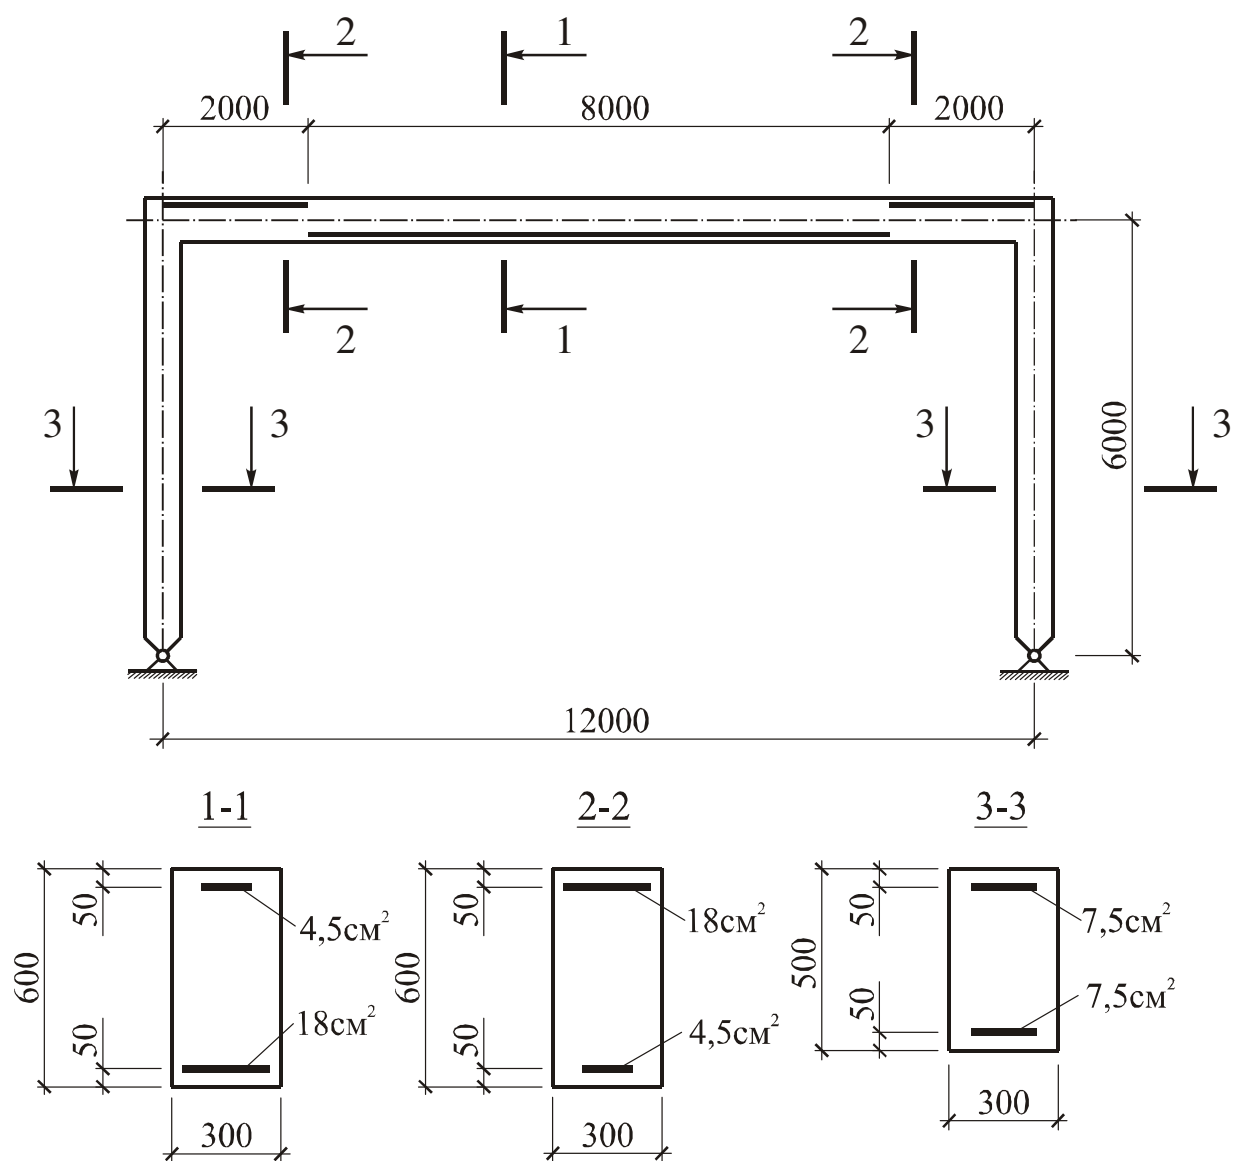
Конструкция двухшарнирной железобетонной рамы
